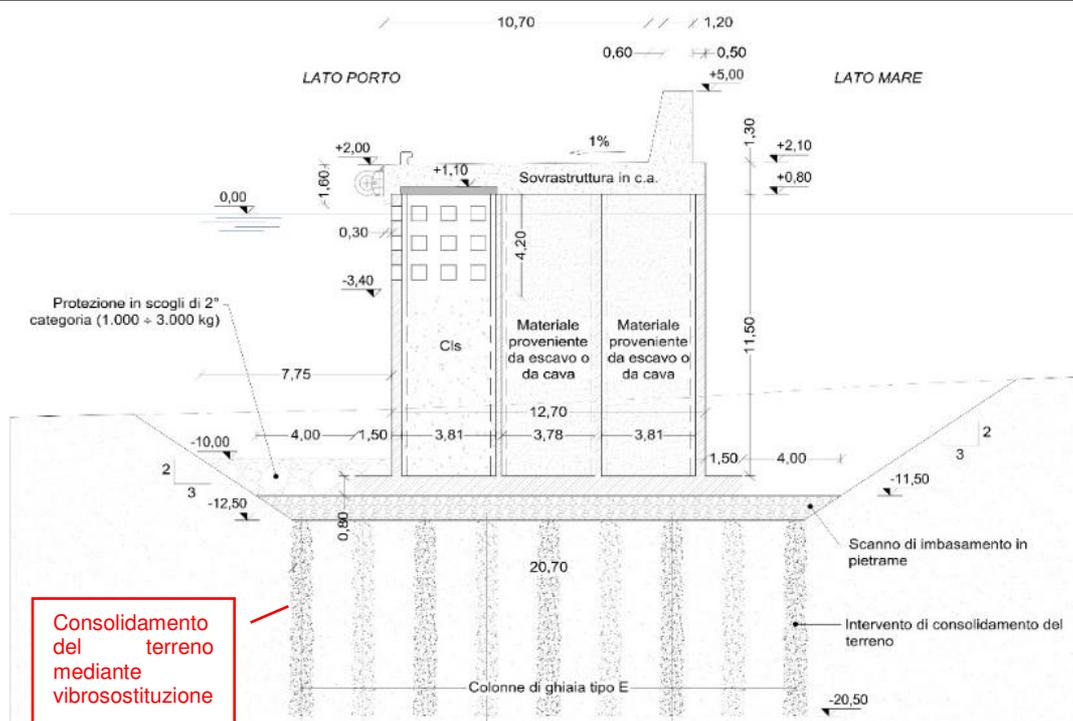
Progetto Esecutivo - Cassone n°3: sezione tipo
